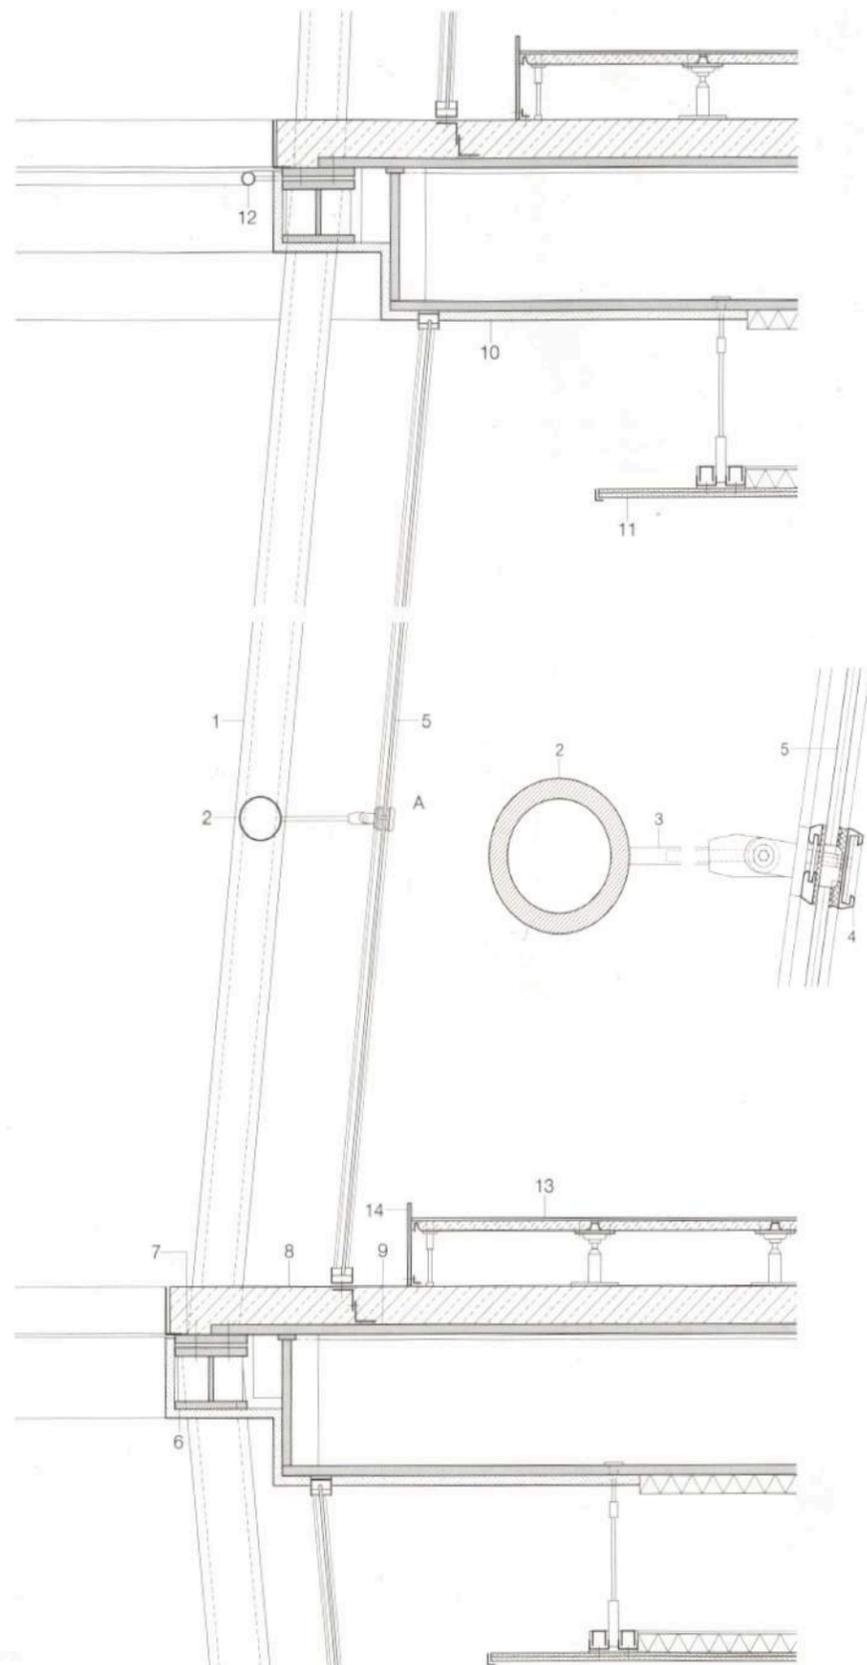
assemblage du plancher aux poteaux [Details, 2011]
